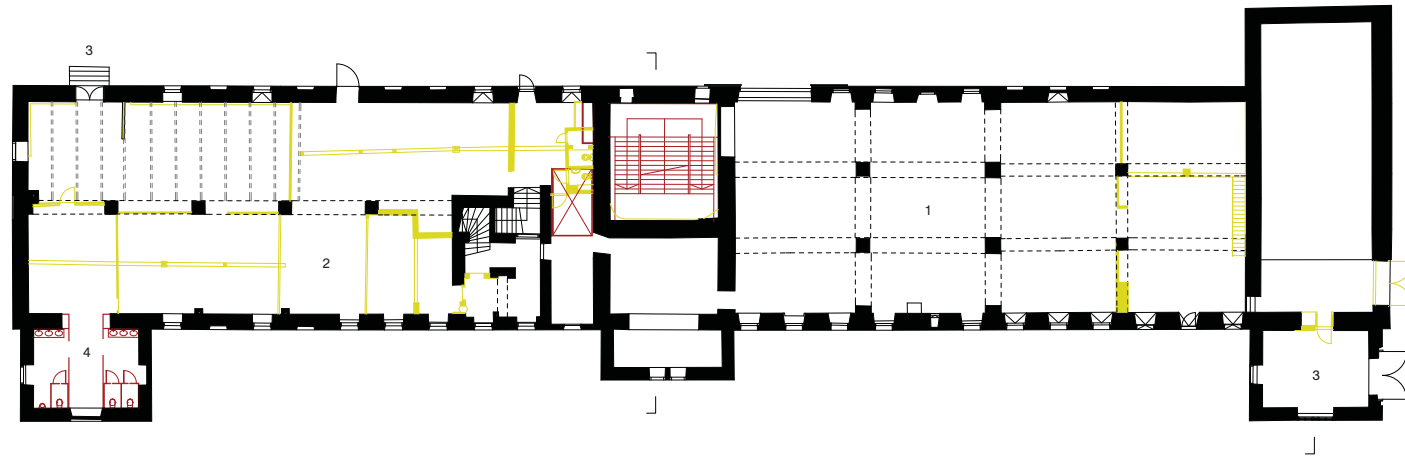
Östliches Lagergewölbe, Erdgeschoss, Brauerei, Gut Guggenthal
